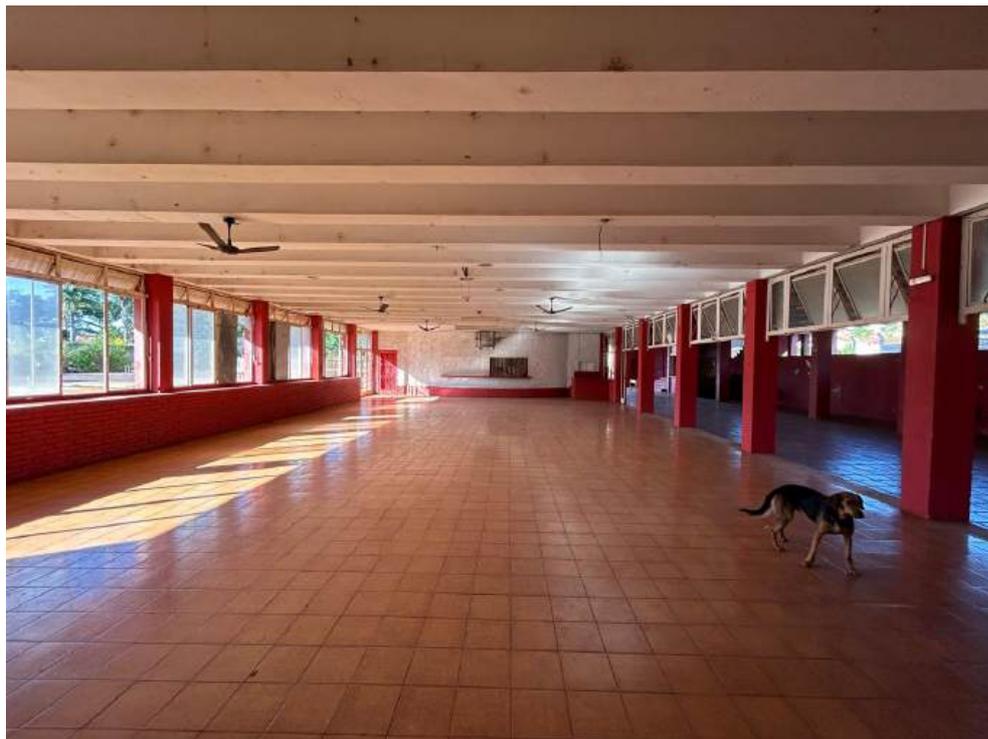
Salão de festa, parte interna do prédio principal, piso inferior
